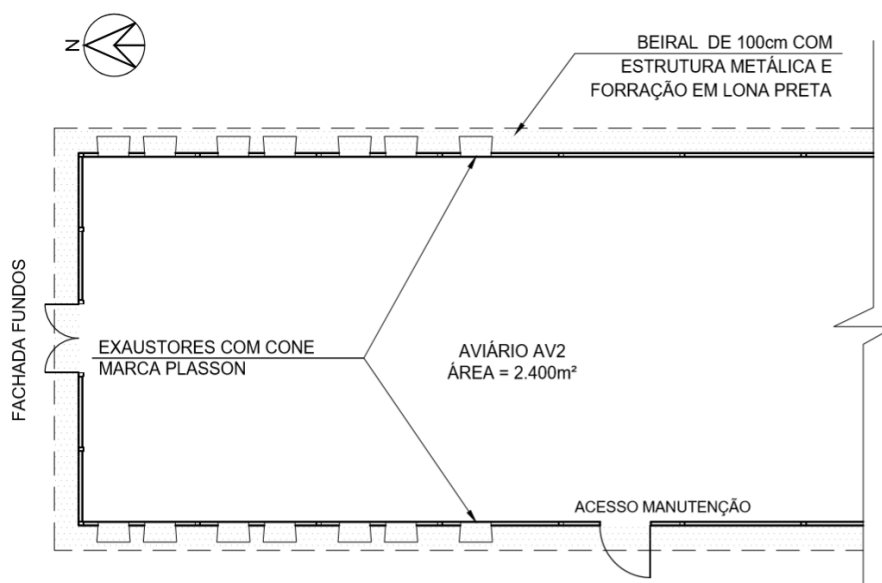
Planta baixa com a localização do sistema de ventilação - exaustores.
